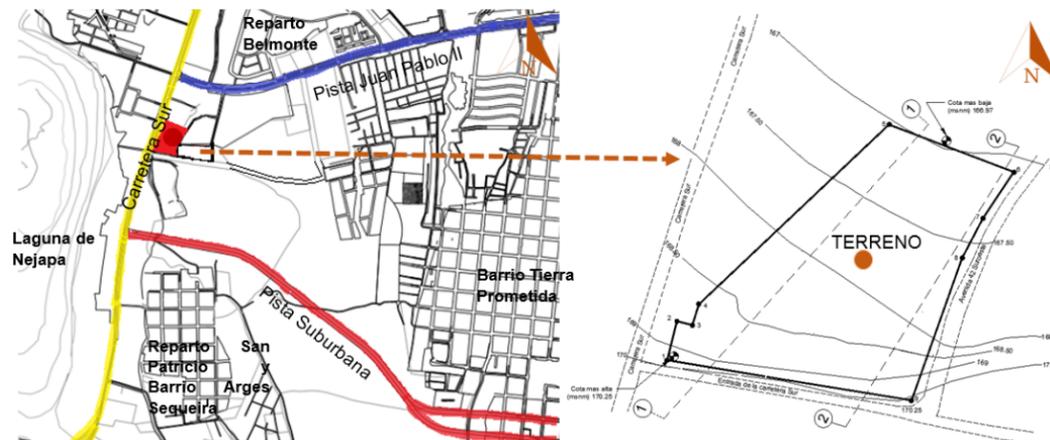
plano de síntesis del terreno. Fuente: modificado por autores.
